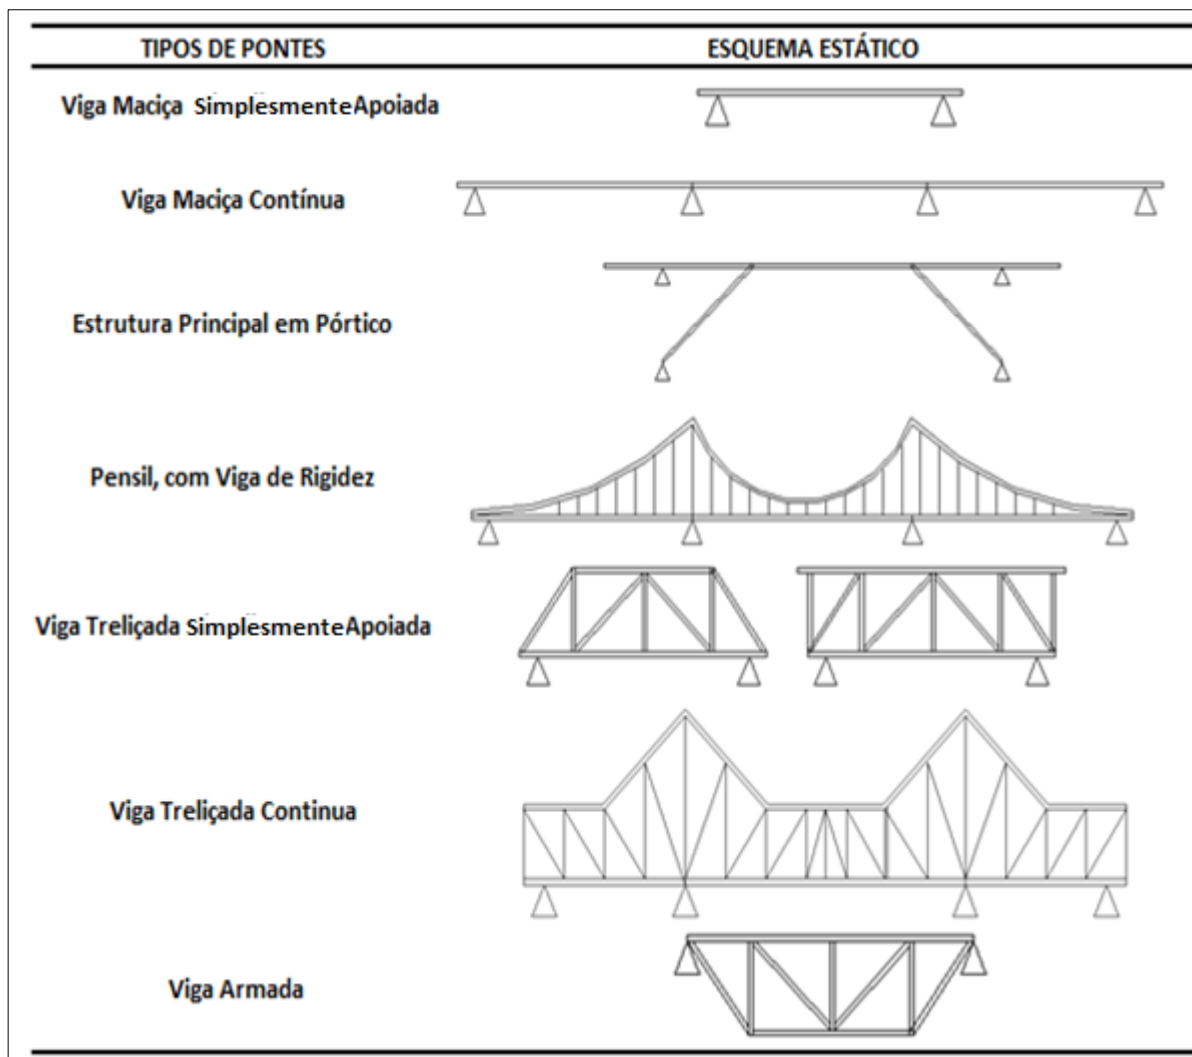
Tipos Estruturais de Pontes em Madeira.
